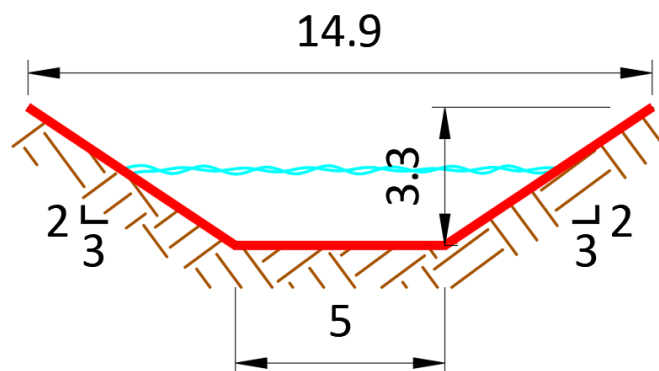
Nuova sezione di progetto dell'alveo.
